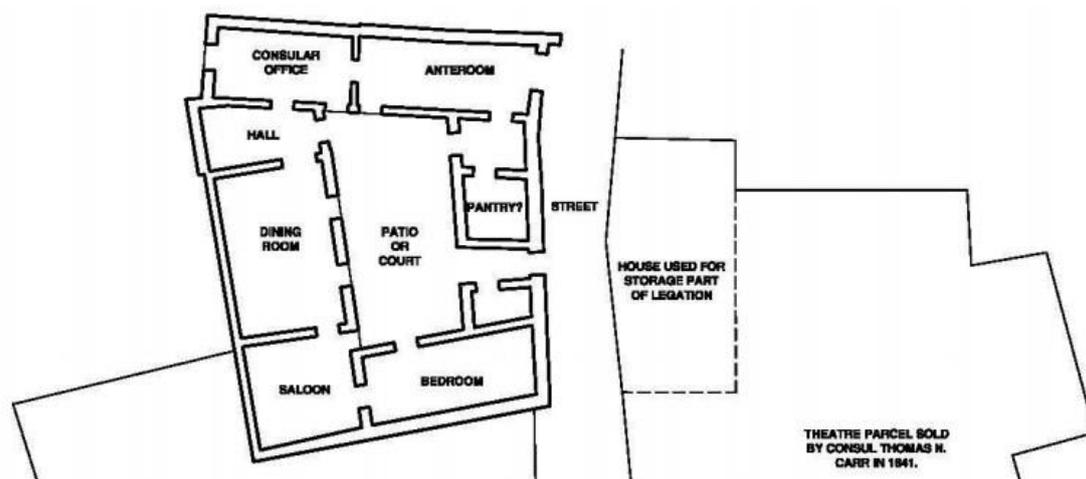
Plano de la planta baja de la legación hacia 1838 (II. Architectural 2010)
